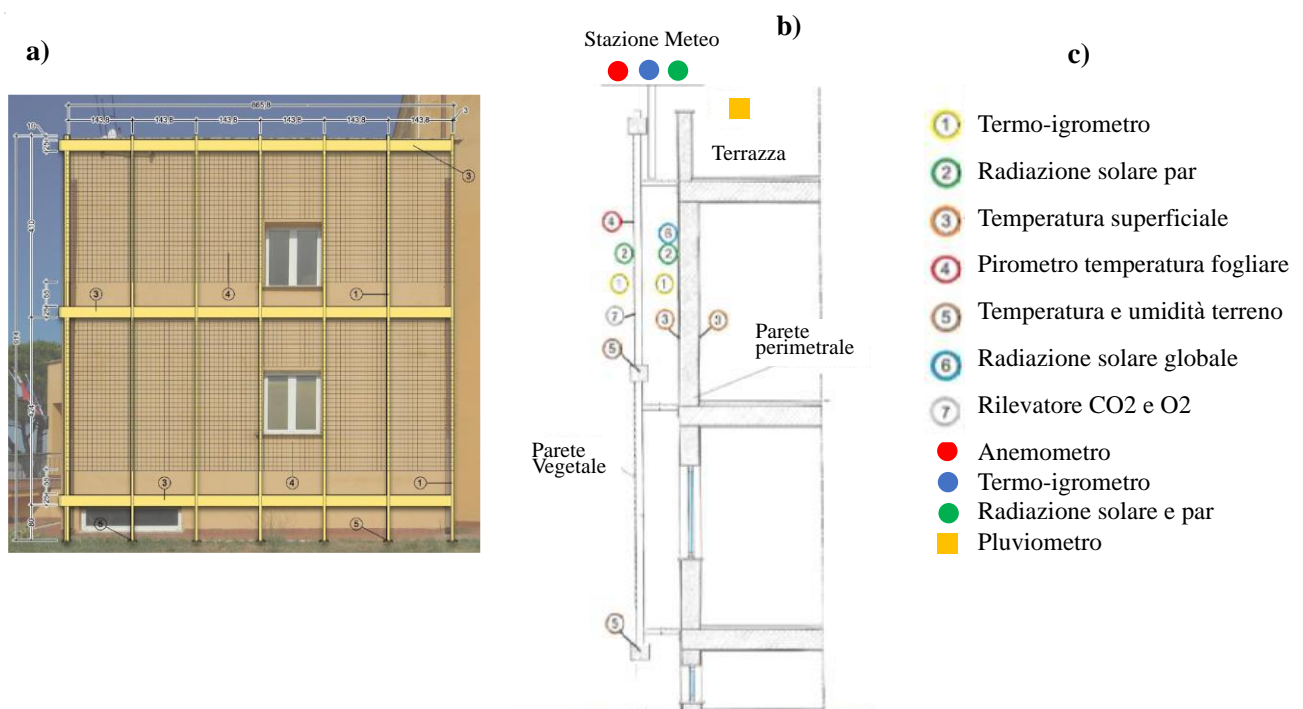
a) Prospetto della struttura di supporto del verde; b) Sezione della parete con evidenziati i sensori posizionati; c) Dettaglio dei sensori
